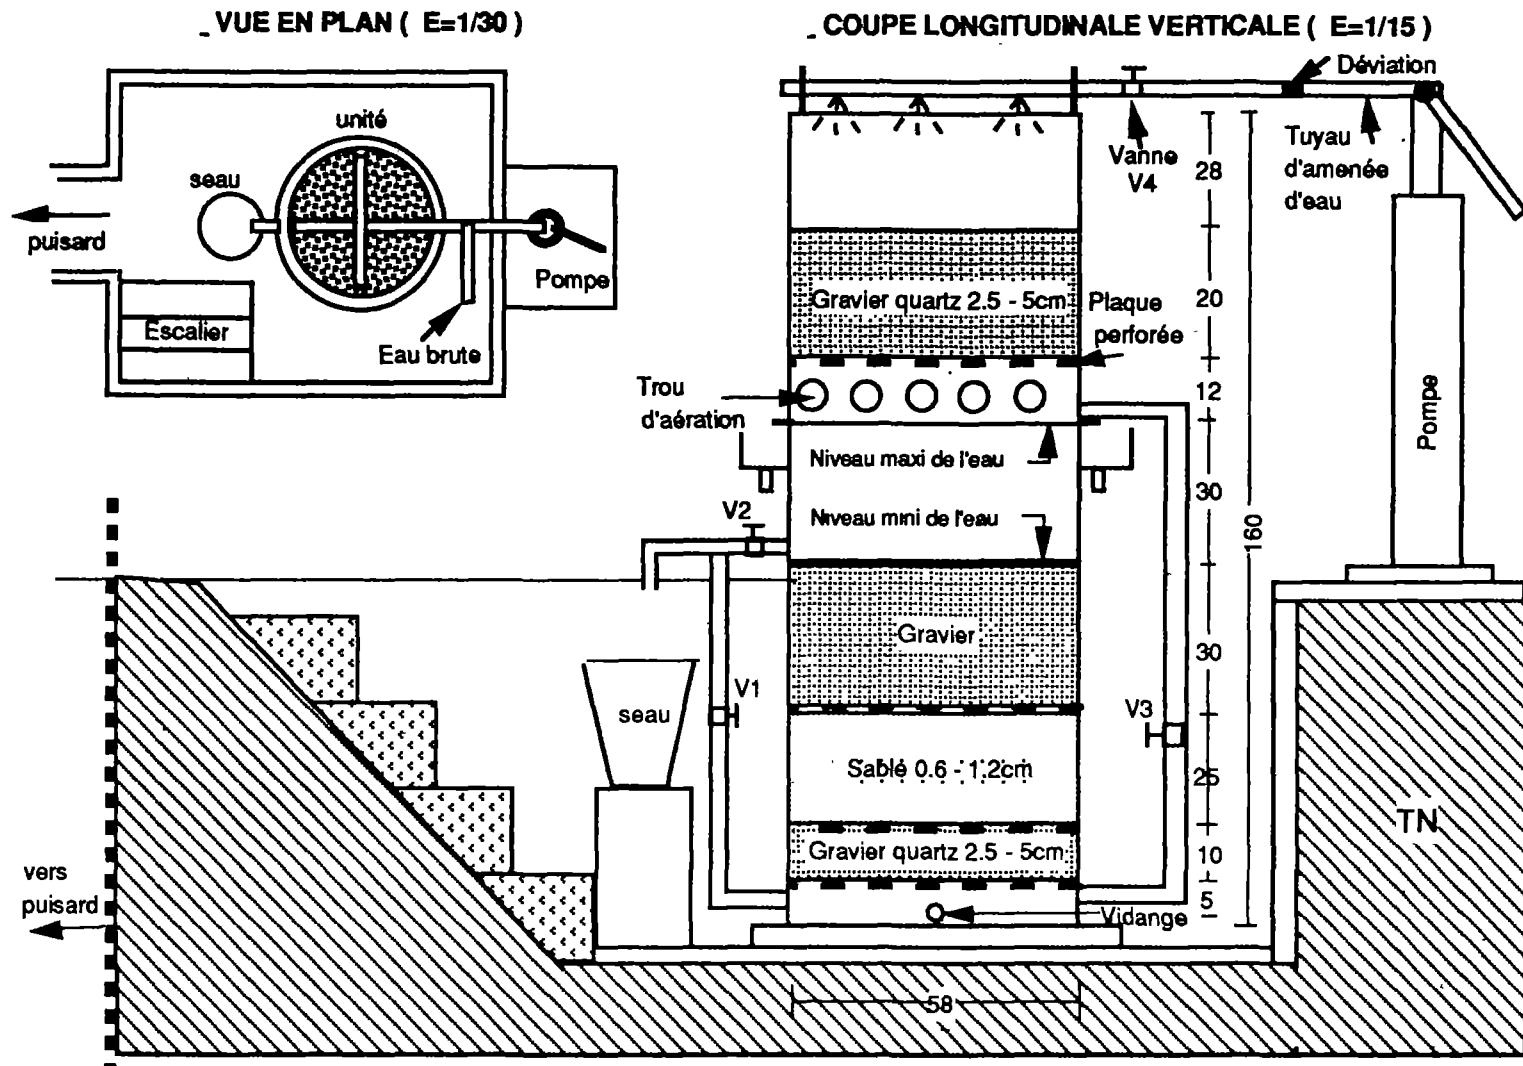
Vue en plan et coupe du dispositif de déferrisation type "AF" métallique
